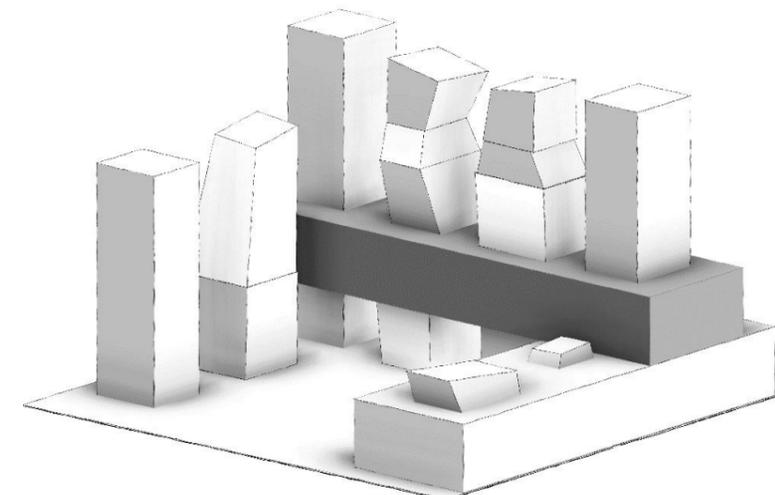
Bloque de vivienda y Coliving liberando la planta baja.
